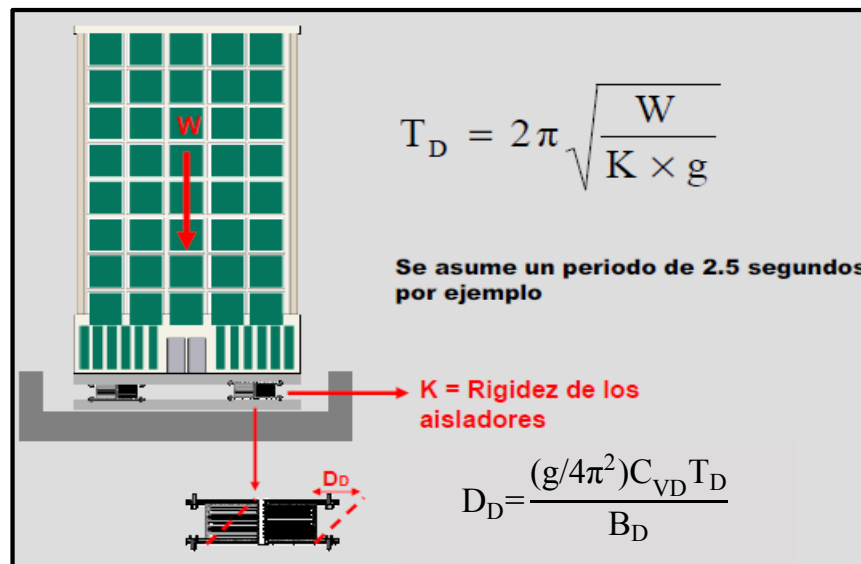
344: Fórmulas para el Periodo de la estructura aislada y el desplazamiento de los aisladores
